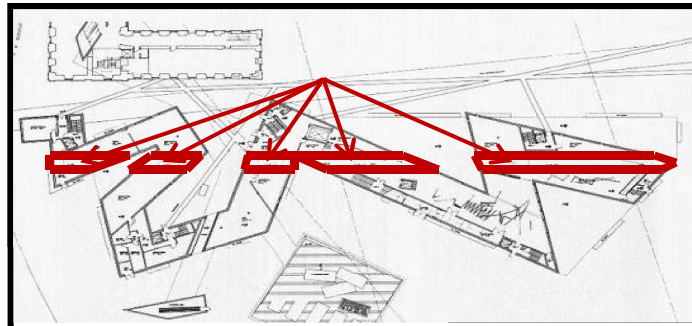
plan rez-de-chaussée du musée juif de Berlin
